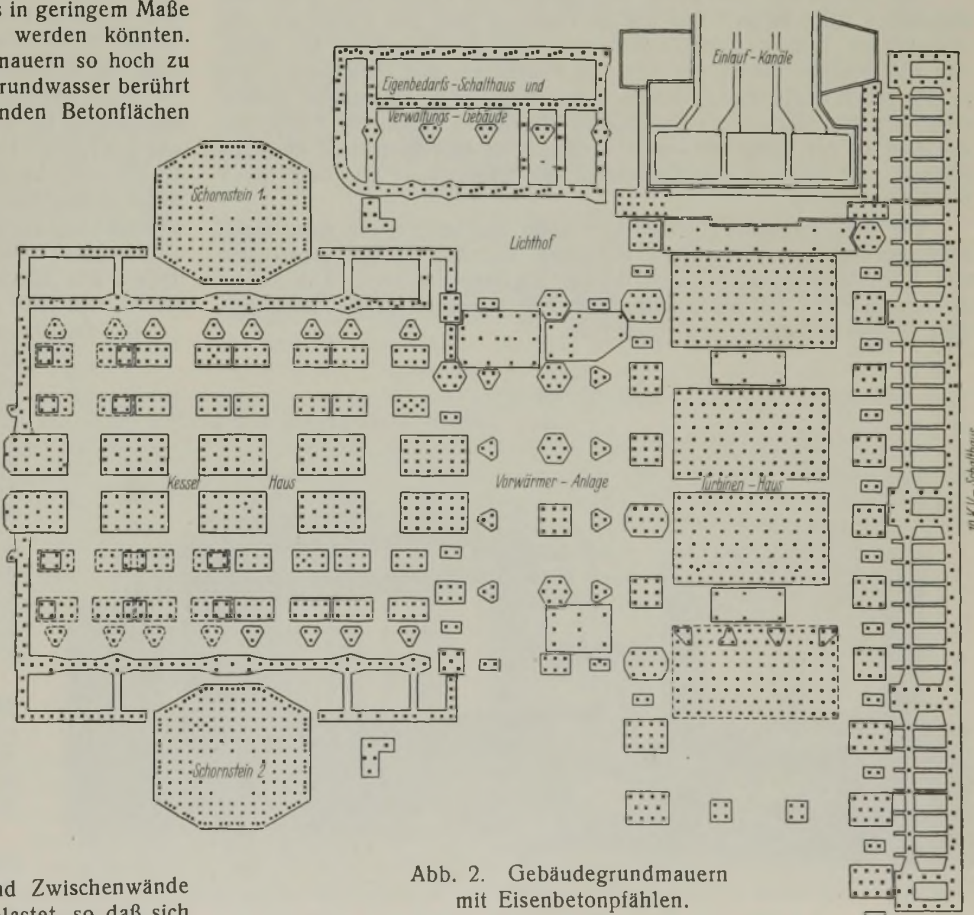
Gebäudegrundmauern mit Eisenbetonpfählen.
